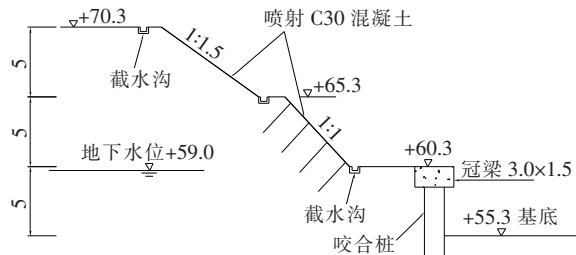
两级放坡开挖+咬合桩方案立面布置图(单位:m)
